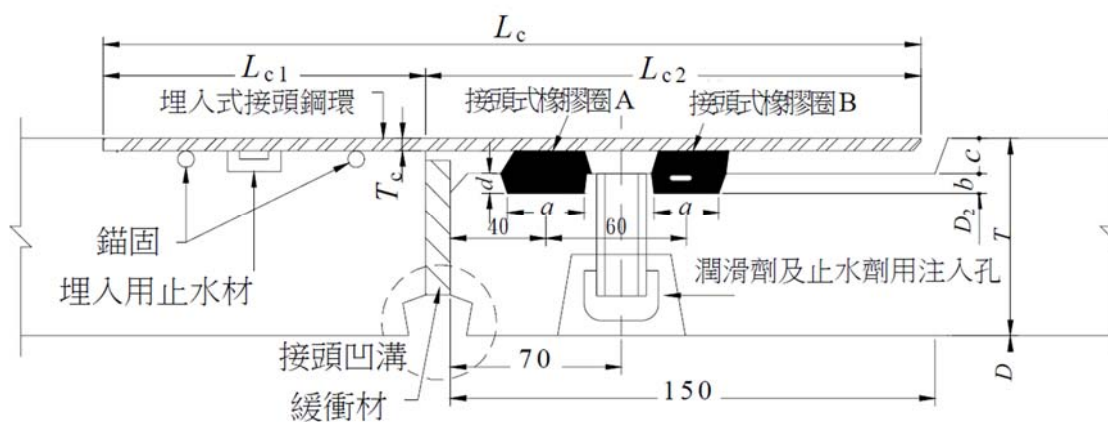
E 型接頭(鋼筋混凝土管)
